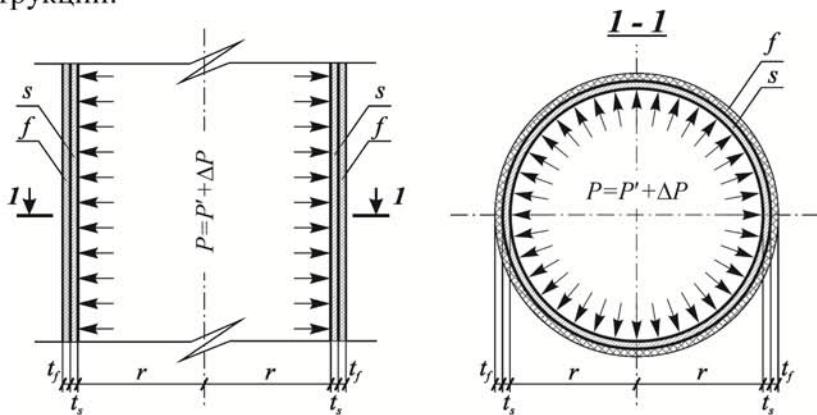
Расчетная схема стальной оболочки цилиндрического резервуара, усиленной внешним поперечным фибропластиковым армированием: s — стальная оболочка резервуара, f — слой внешнего поперечного фибропластикового усиления
